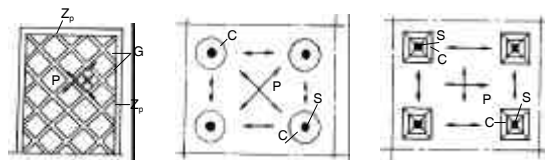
Planșee din beton armat monolit. Tipuri. Transmiterea încărcărilor de la planșee la elementele verticale ale structurii
